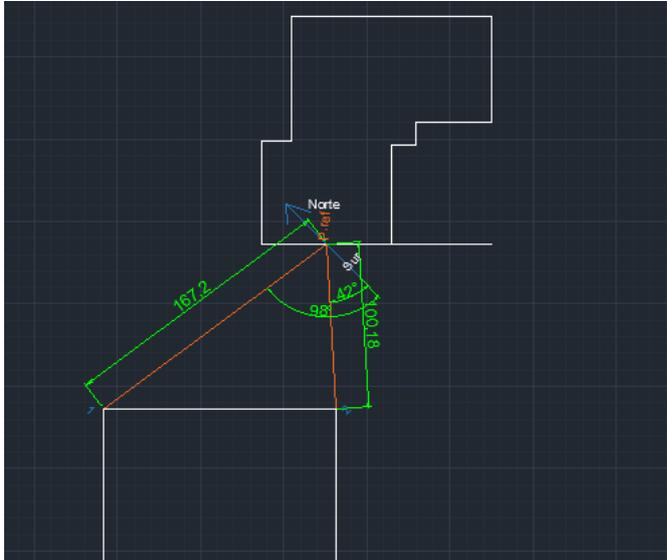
Determinación de los ángulos de los obstáculos sombreando Fachada Sur
